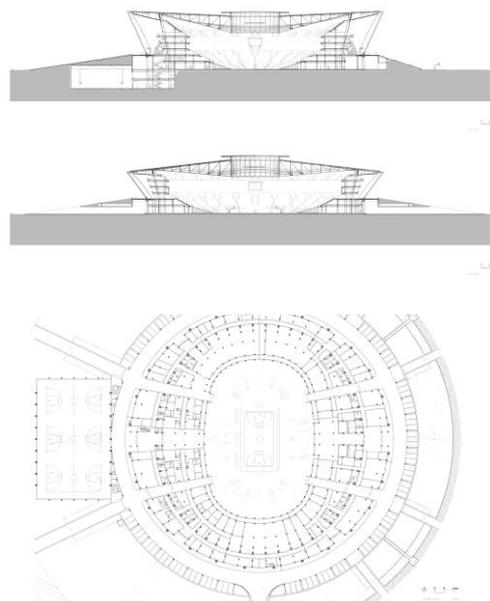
Planta y Corte Estadio de Baloncesto en Dongguan
